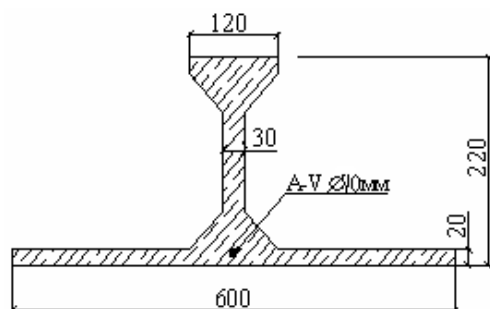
Поперечное сечение плиты перекрытия L=6000 мм
